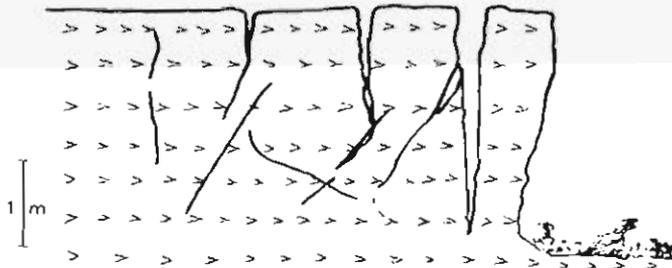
Proceso de fisuración y disolución de las capas selenitosas del grupo geotécnico 32a', con el consecuente derrumbamiento, en vertical, - de las extensas paredes del talud. Cra. local de Pinarejo a San Clemente (unos 3.5 Kms al sur de Pinarejo).
